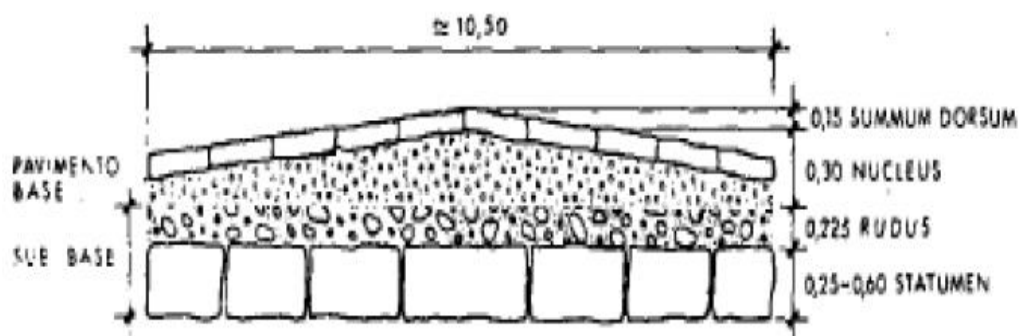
23: Estrutura antiga de pavimento com pedra basáltica
